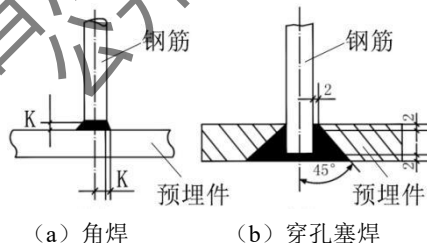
预埋件钢筋电弧焊 T 形接头
